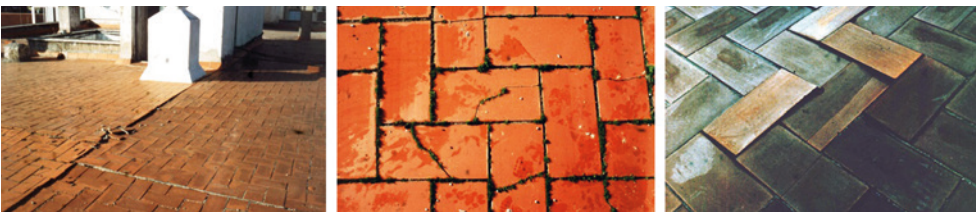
Tres casos de defectos en el pavimento de rasilla. De izquierda a derecha, junta de movimiento con roturas, presencia de vegetación en las juntas de mortero y adherencia insuficiente de las rasillas al mortero.
